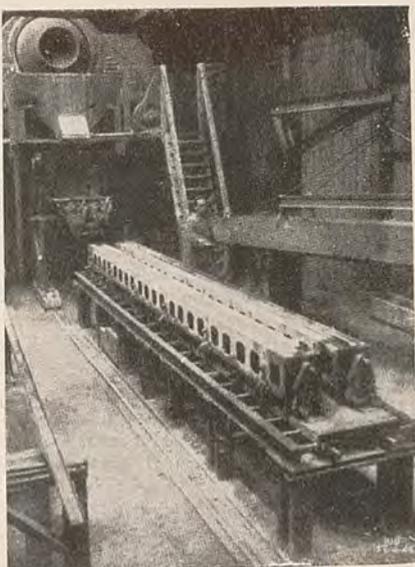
Forme metalliche per travetti precompressi in uno stabilimento per la costruzione di elementi murari prefabbricati.
